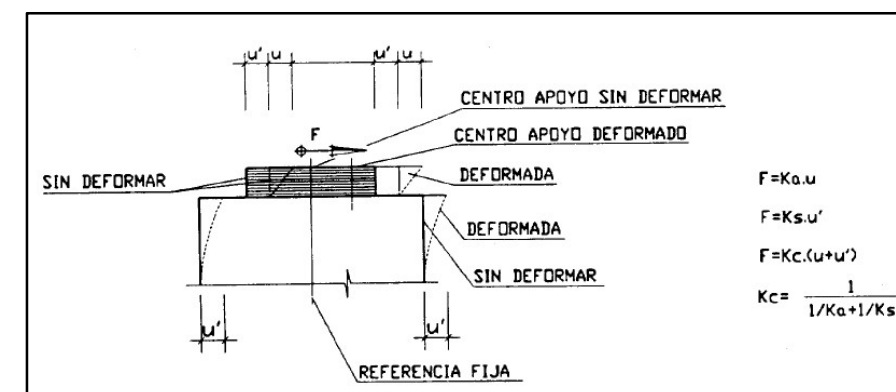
Rigidez total del elemento: apoyo + subestructura.
